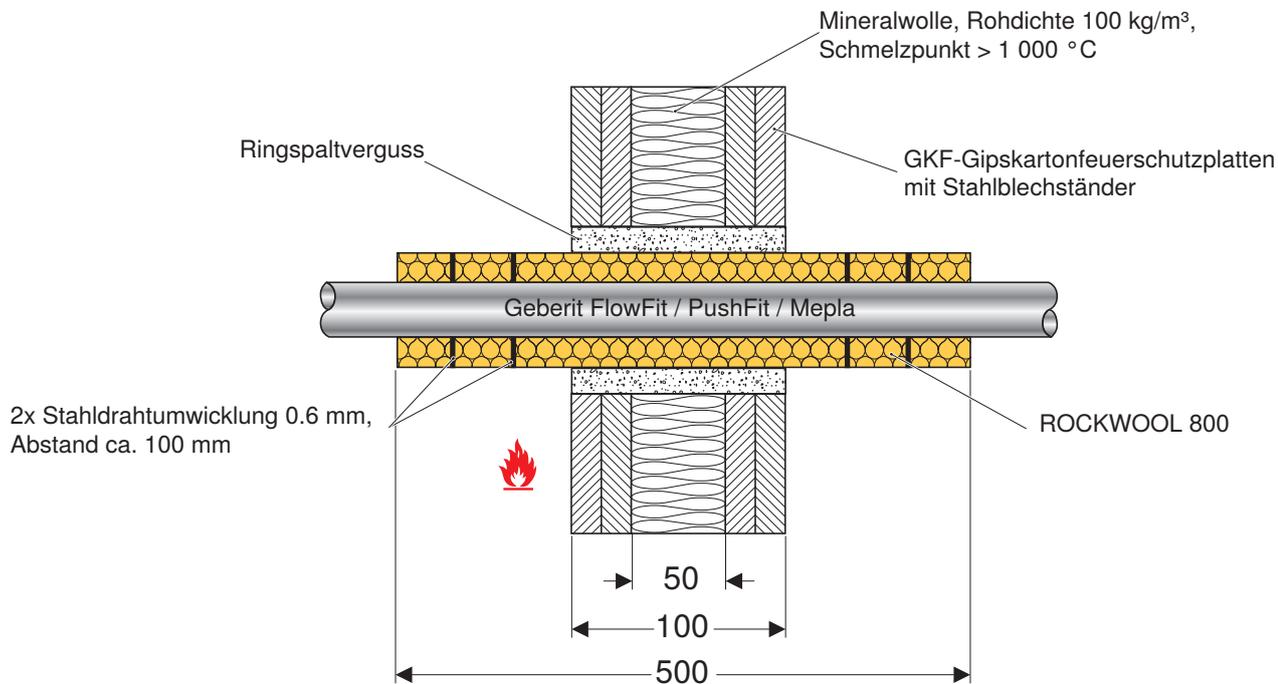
Wanddurchführung Massivwand/Leichtbauwand
